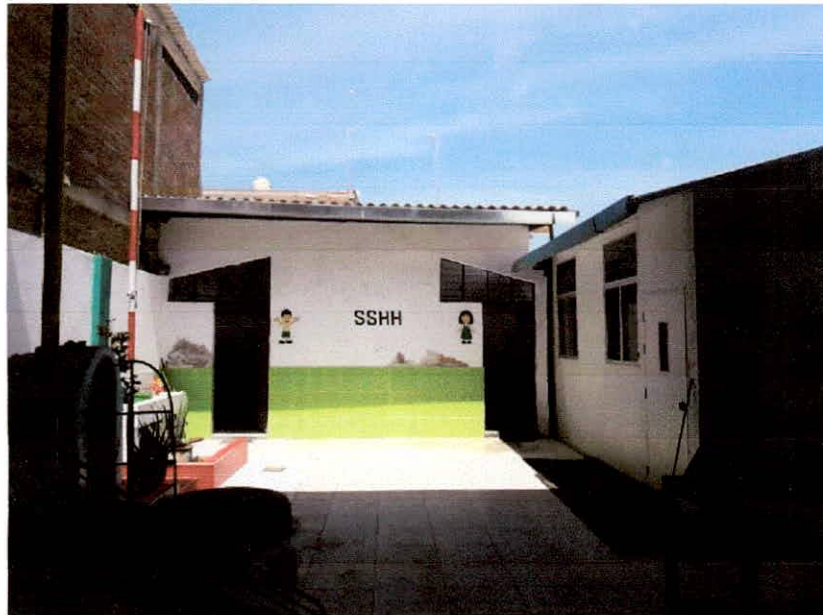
Vista elevación del pabellón B, cuenta con cobertura liviana en eternit. Si bien se encuentra con mantenimiento, se puede constatar el deterioro de la estructura.
